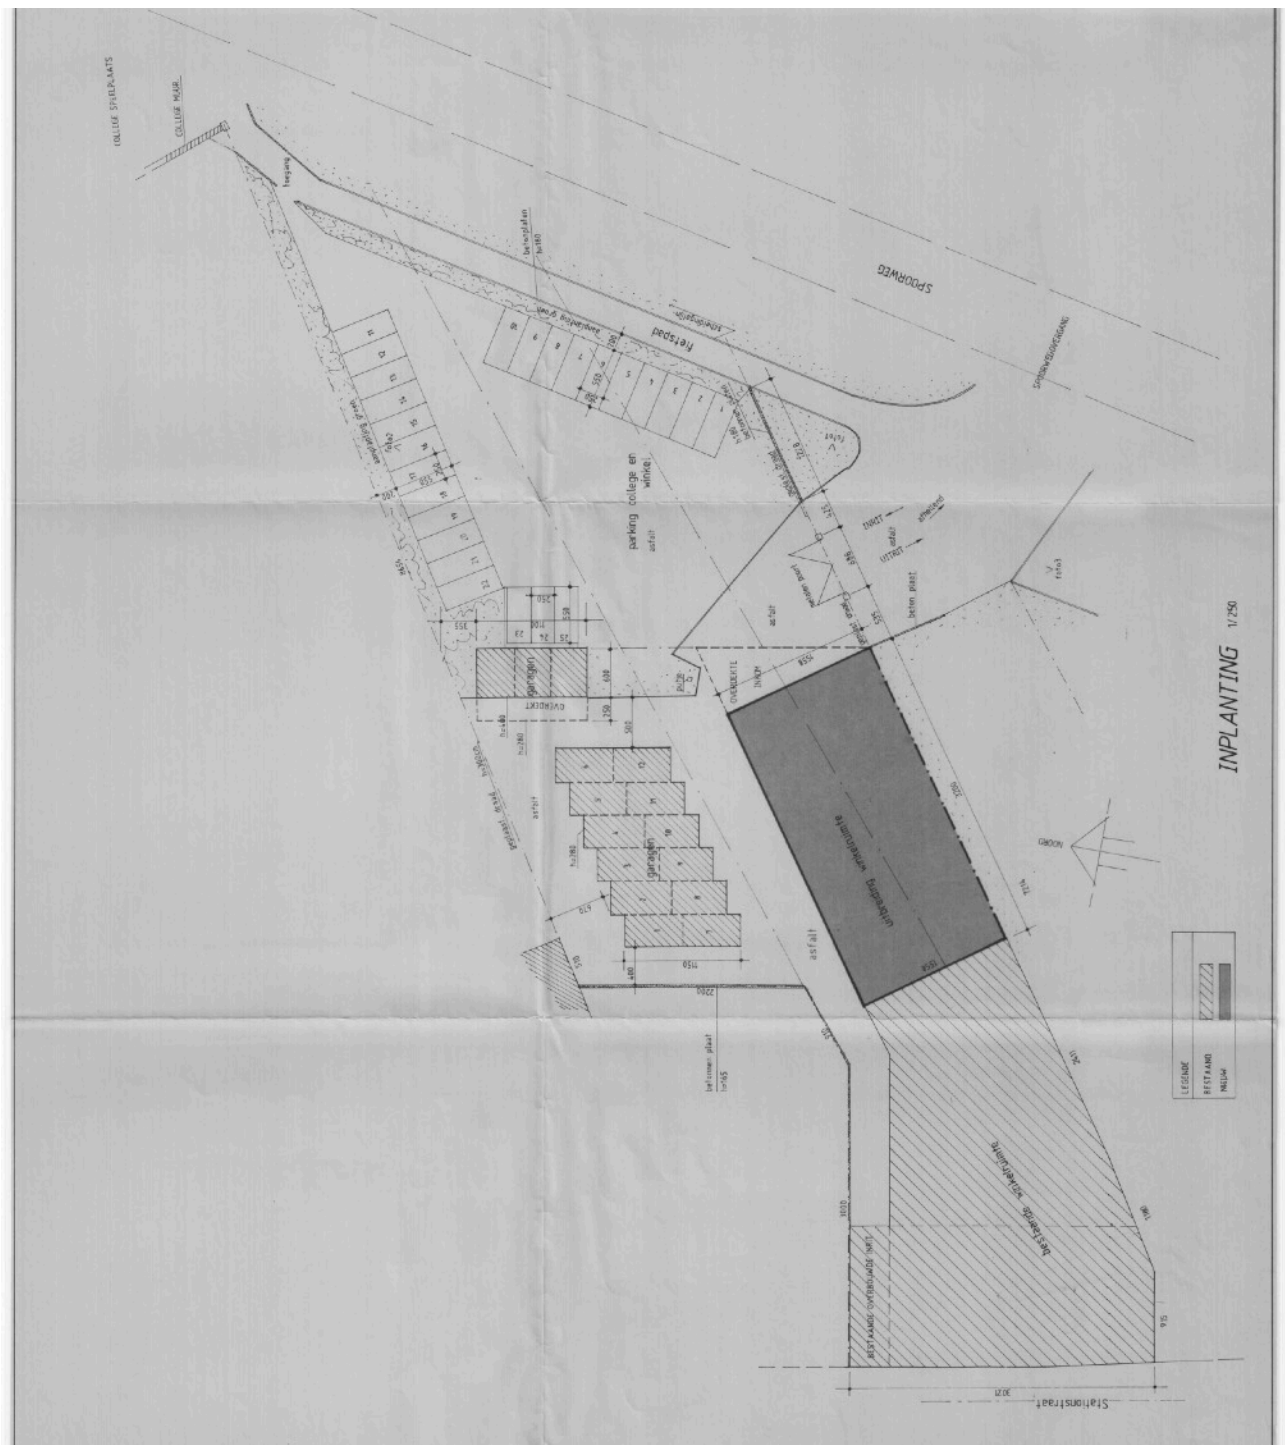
Inplantingsplan van de situatie in 1996. © Wouters Ludo
